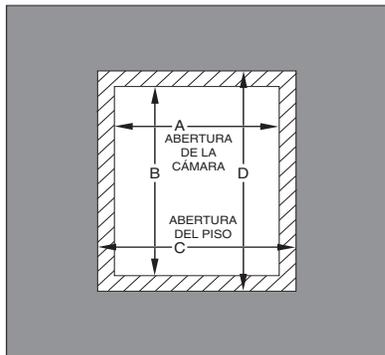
Dimensiones de las aperturas del piso y la cámara
